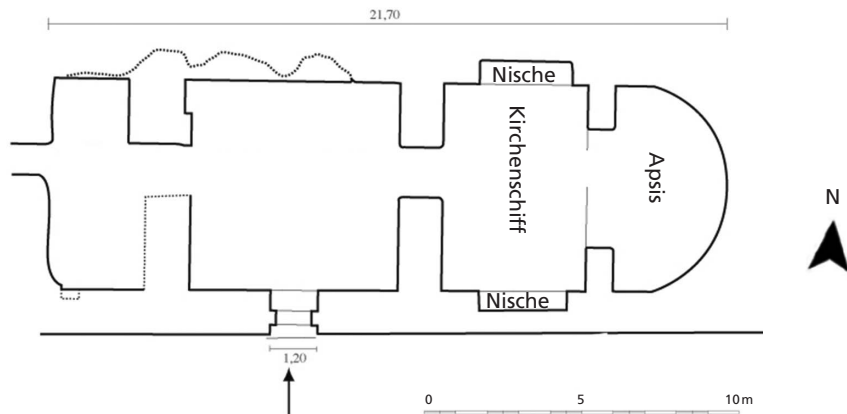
Magaret el-Ruhban, Felsenkirche, Grundriss. – (Nach Abou Sekeh, *Ermittages de l'Hermon* Pl. 3).
